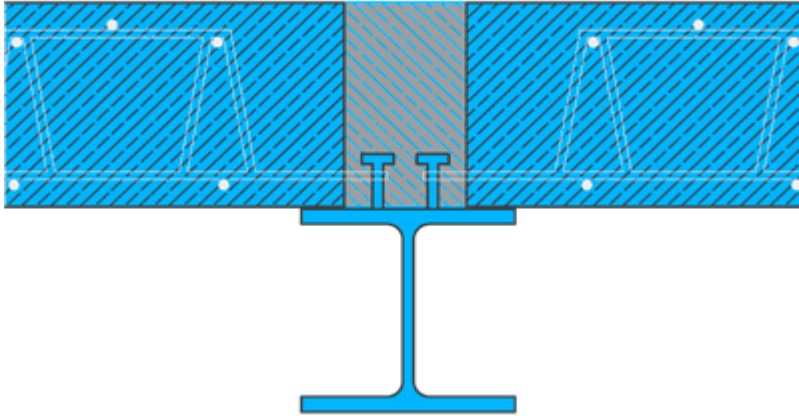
Verbund Stahlträger mit Fertigbetondecke<sup>188</sup>
